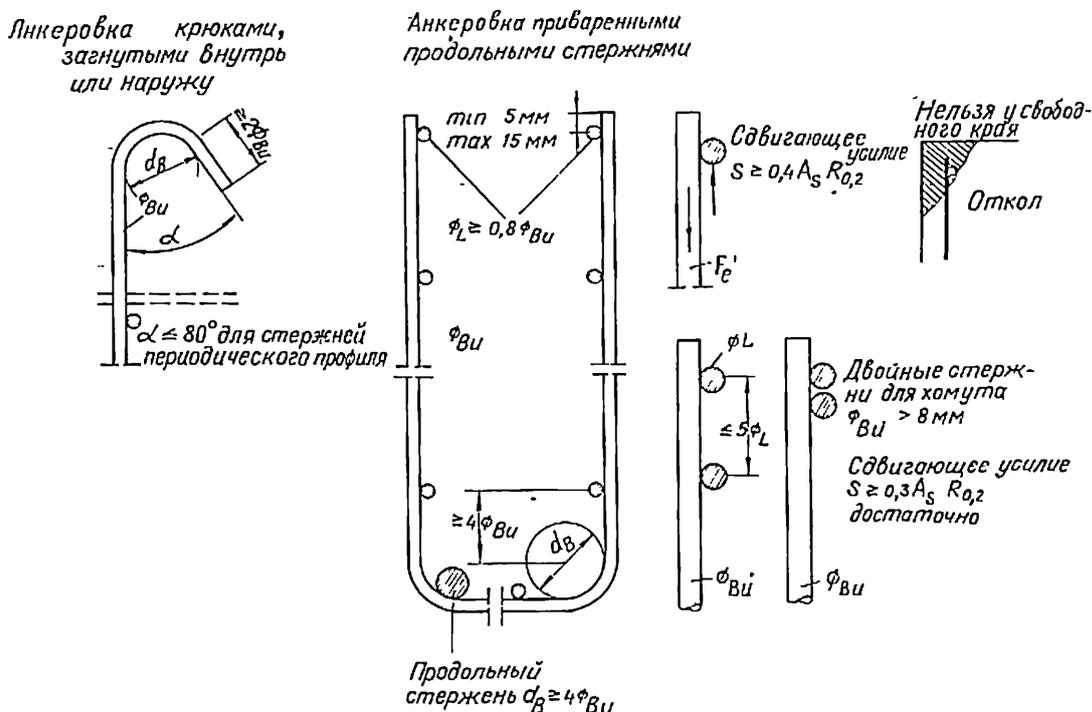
2. Виды анкеровки сварных сеток-хомутов
